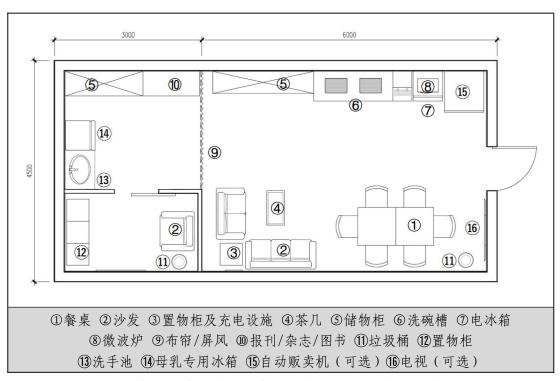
航站区共享休息区+哺乳休息区平面示意图(单位: mm)
